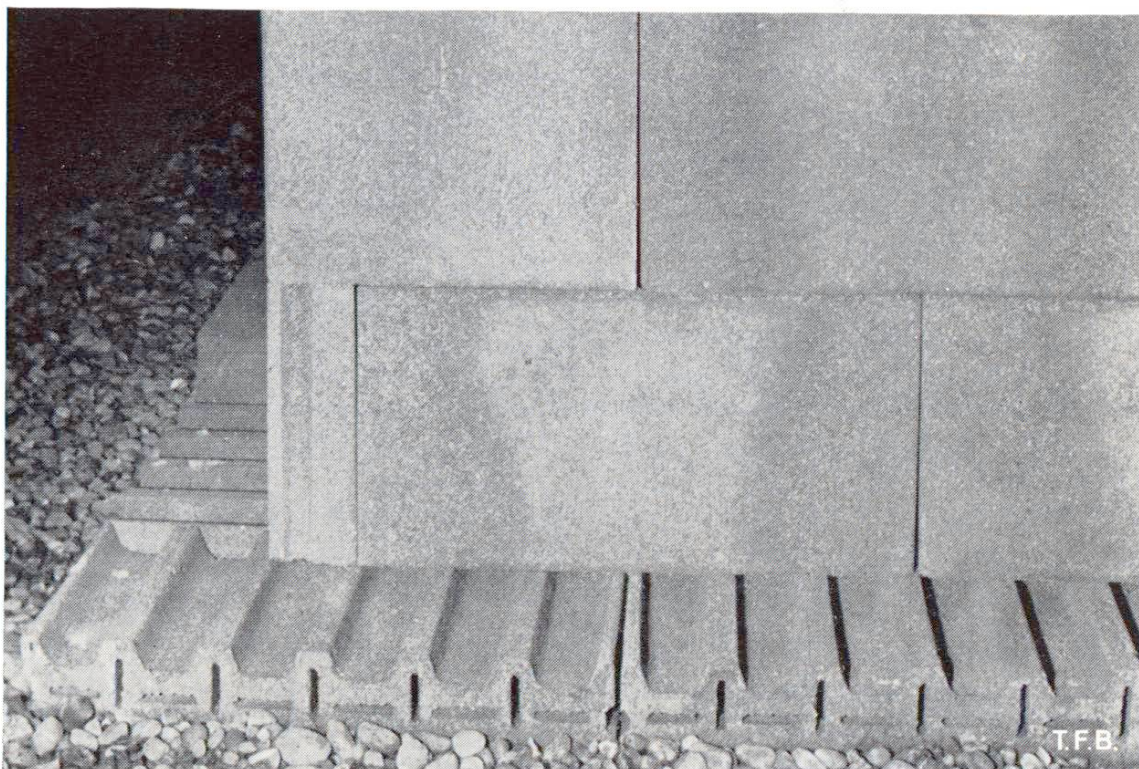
Plaques drainantes à section en zig-zag. La plaque de droite est munie d'une moulure destinée à fermer les canaux au haut de la paroi drainante.
